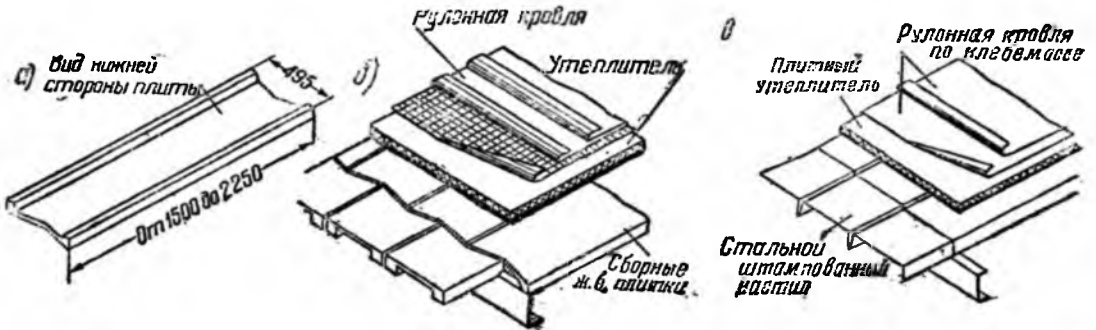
Сборные железобетонные плитки и стальной настил по стальным прогонам
